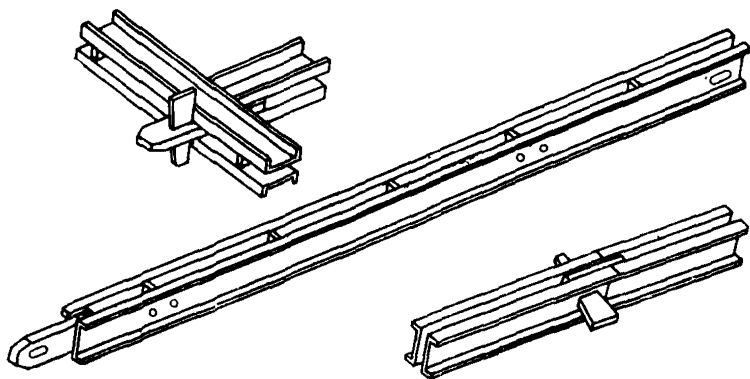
Общий вид и способы соединения стальных схваток опалубки конструкции ЦНИИОМТП
